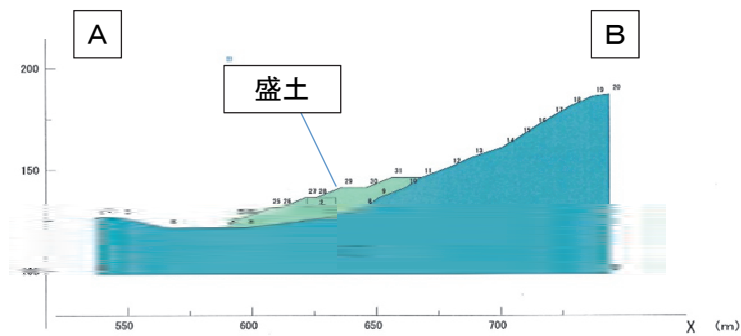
(4) 予測計算断面図 (断面 4)
